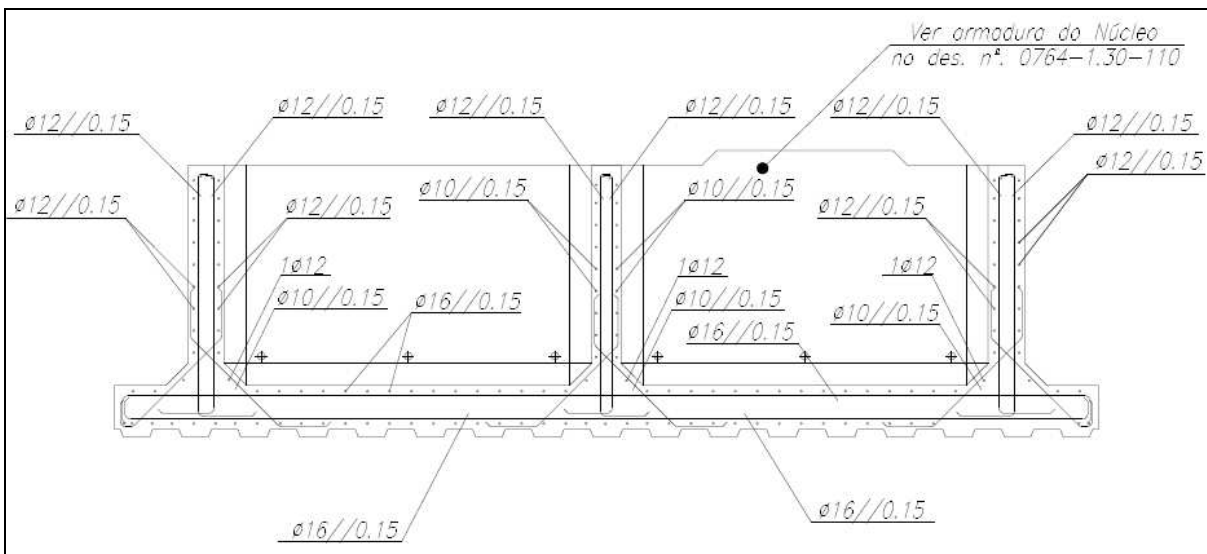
Corte construtivo vertical das aduelas do tipo A1 (imagem do projecto de execução).
